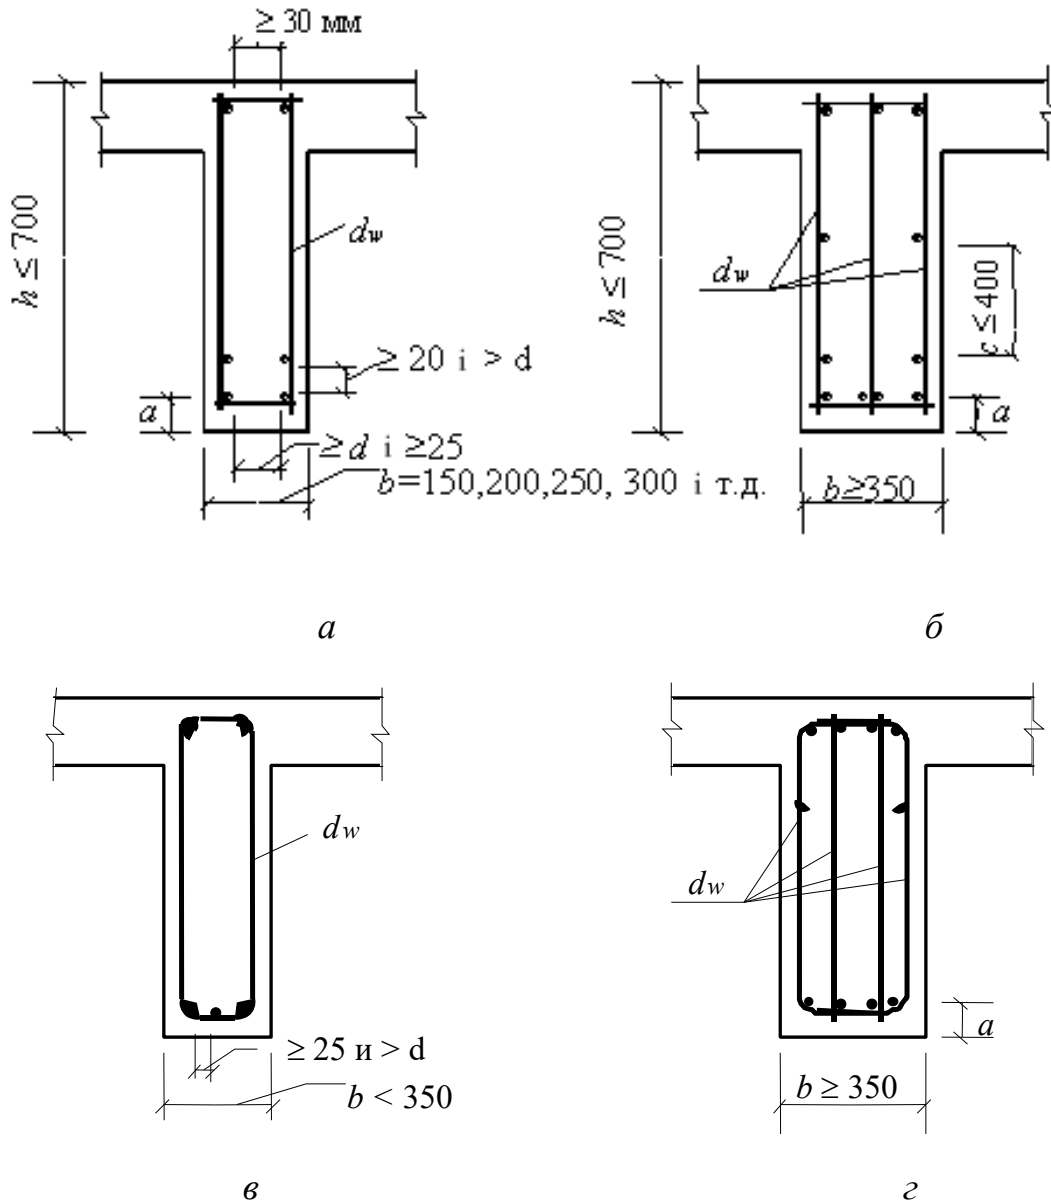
Розміщення арматури в поперечному перерізі балок:
